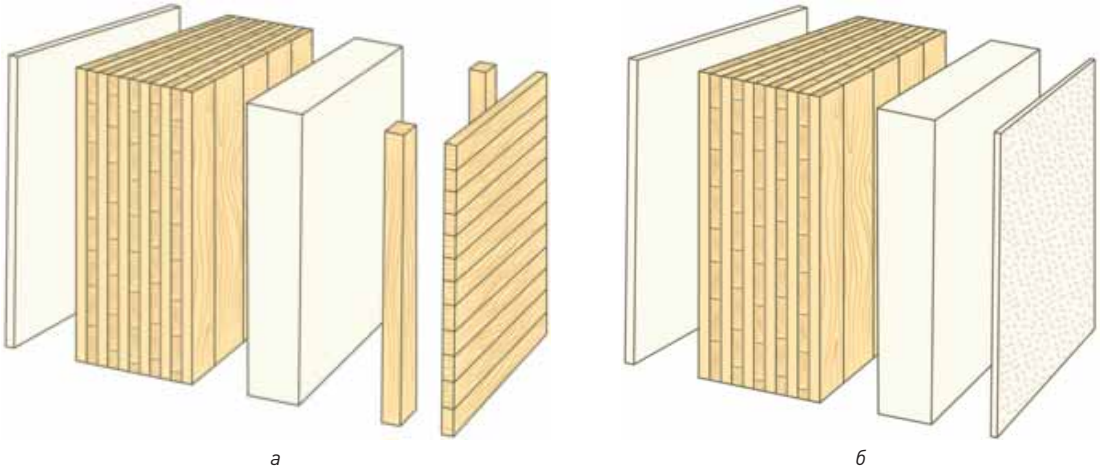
Примеры отделки наружных панелей: а) вентилируемый фасад, б) штукатурный фасад
